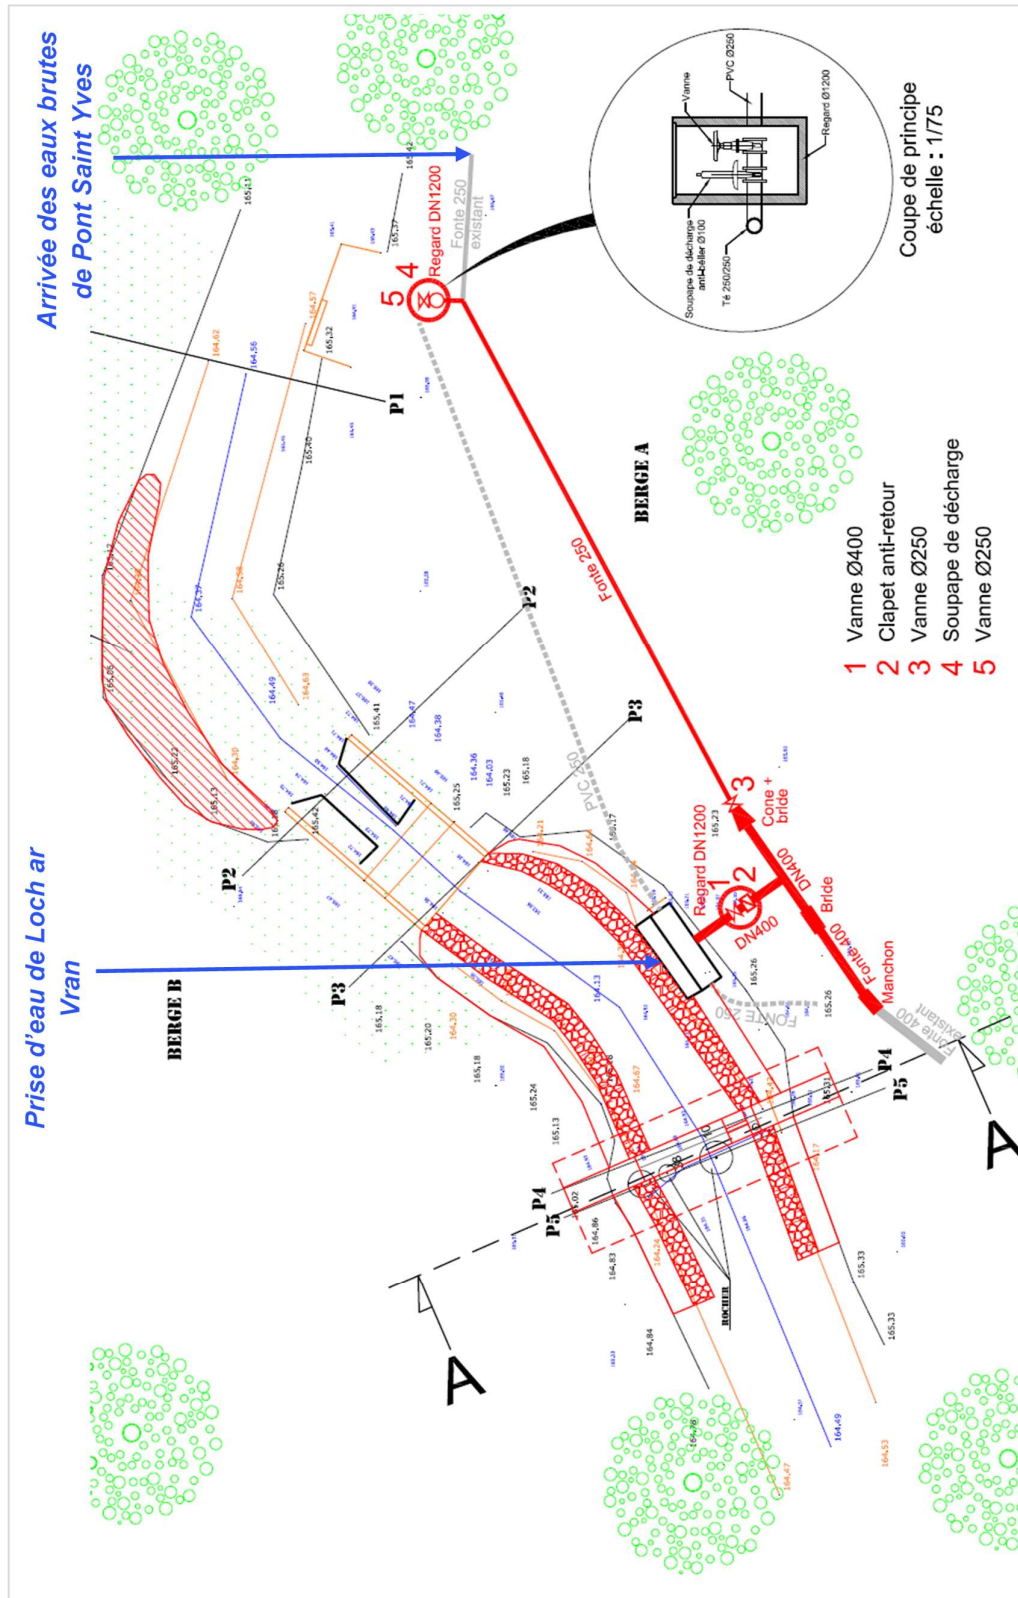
Plan d'implantation de la prise d'eau de Loch ar Vran dans le ruisseau de Goaravec
